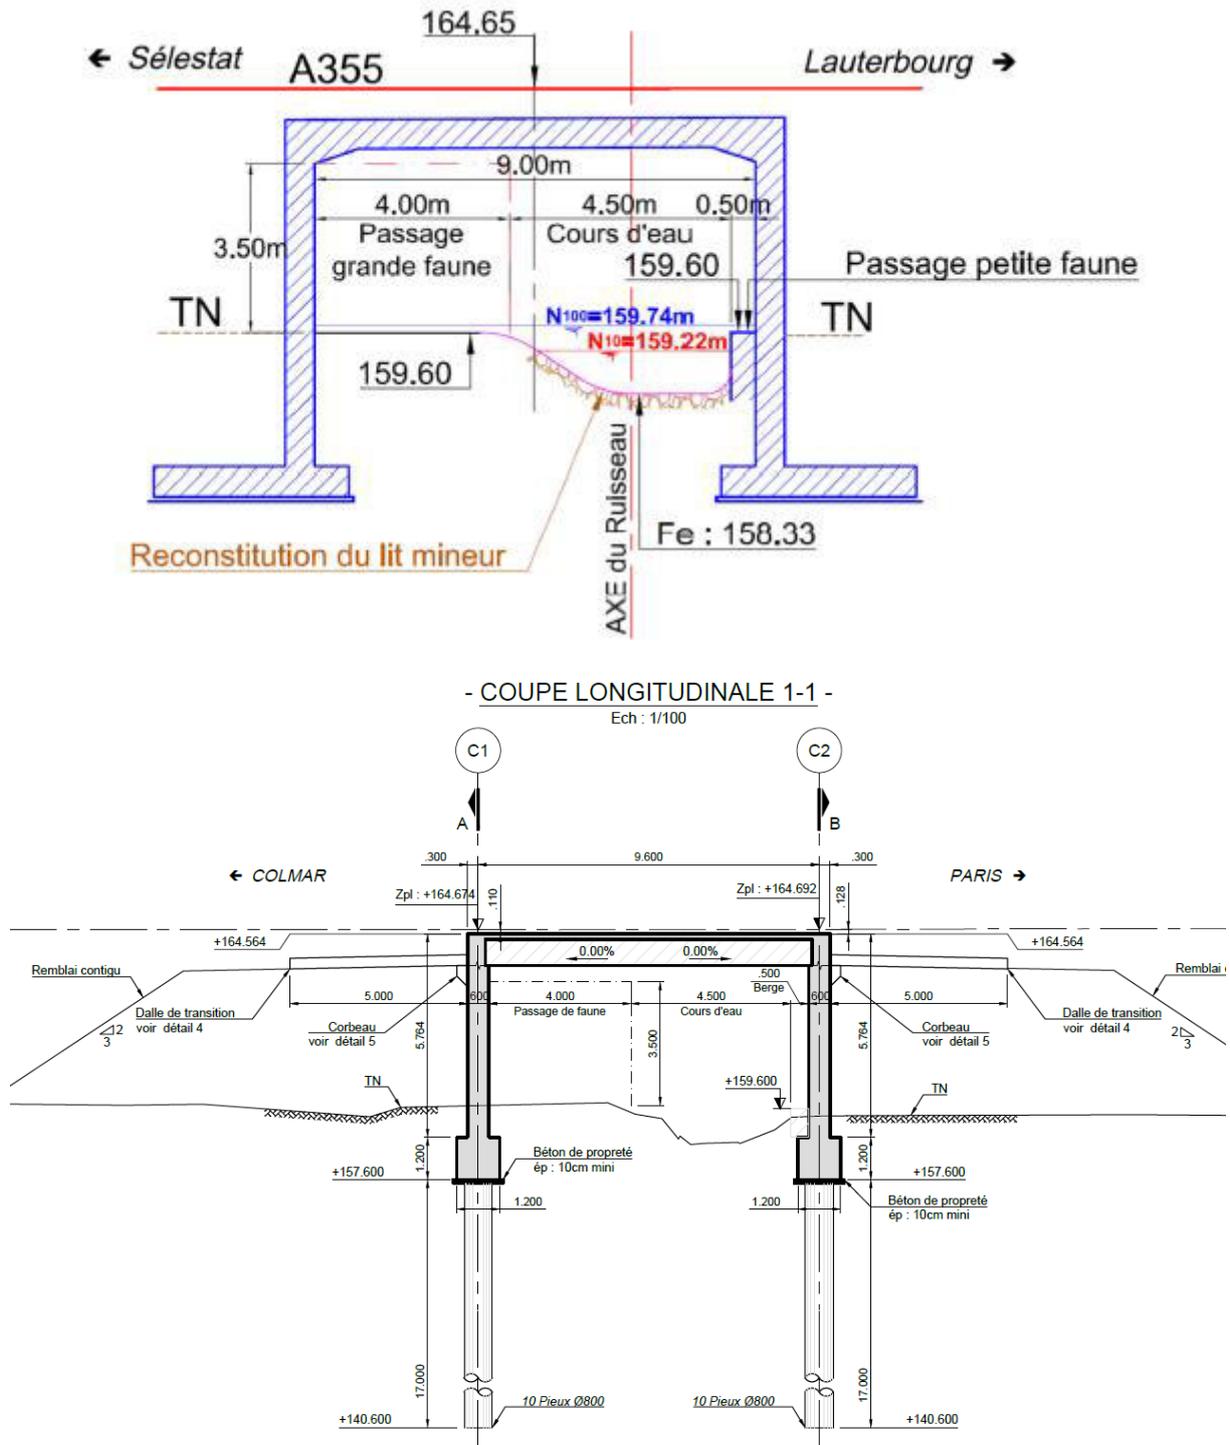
Nouveau dalot de franchissement (SOCOS, extrait étude hydraulique et plan PEN_GMDCB_11624_A2_OHA 00938 - PLAN D'ENSEMBLE)
